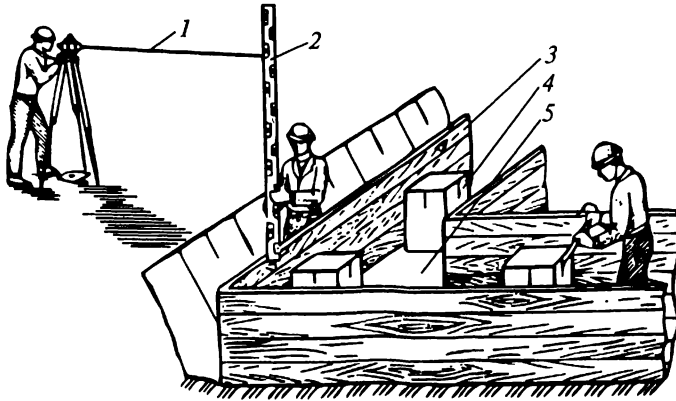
Разбивка осей и отметок для установки арматуры и выверки опалубки (арматура условно не показана):
